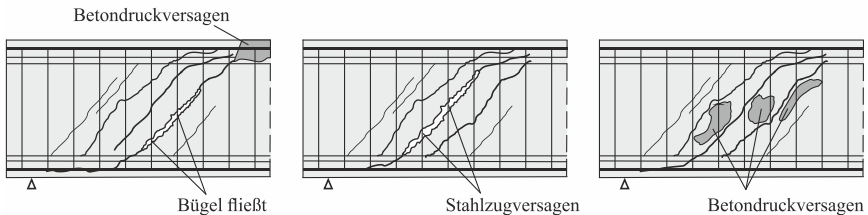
Versagensmodi profilierter Stahlbetonträger – Biegeschubversagen (links), Zugversagen der Querkraftbewehrung (Mitte) und Druckversagen des Stegbetons (rechts)
